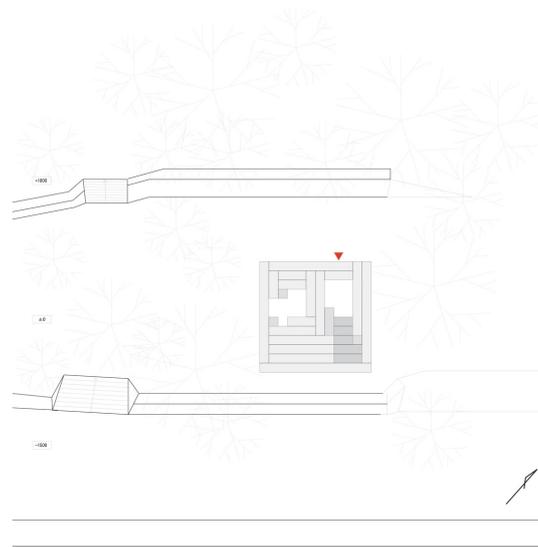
Sou Fujimoto - *Casa Final de Madeira*, Kumakura, Japão, 2008. Planta de implantação e Alçados.
